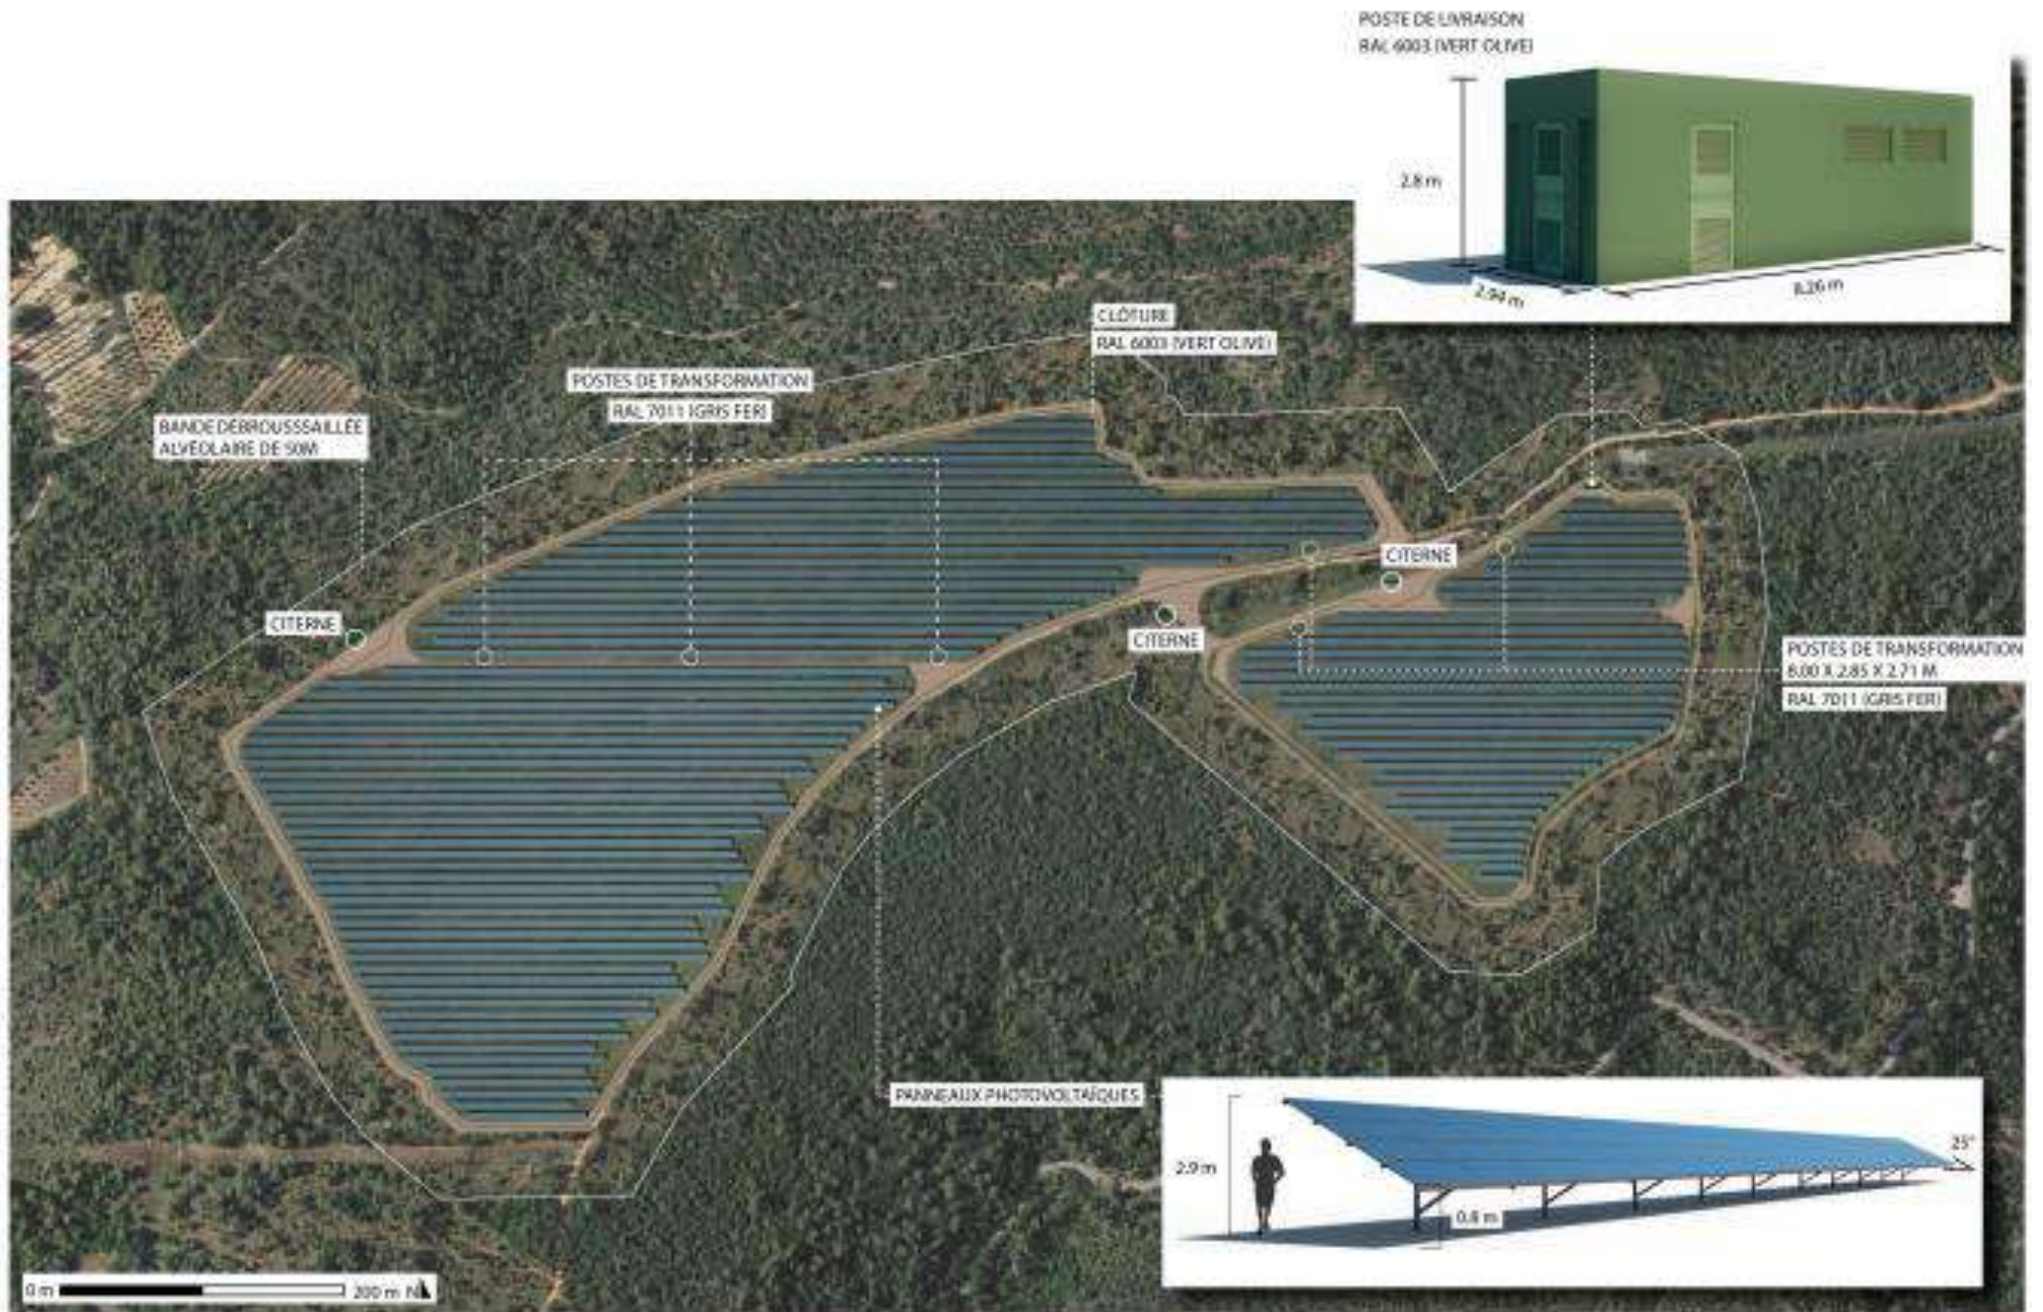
Plan de masse initial du projet (Source : étude paysagère pour la demande de permis de construire en 2020)
